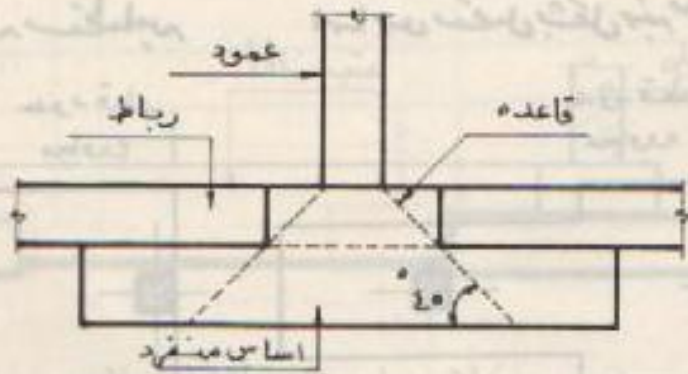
مخطط ومقطع أساس منفرد مع رباط من الخرسانة المسلحة
